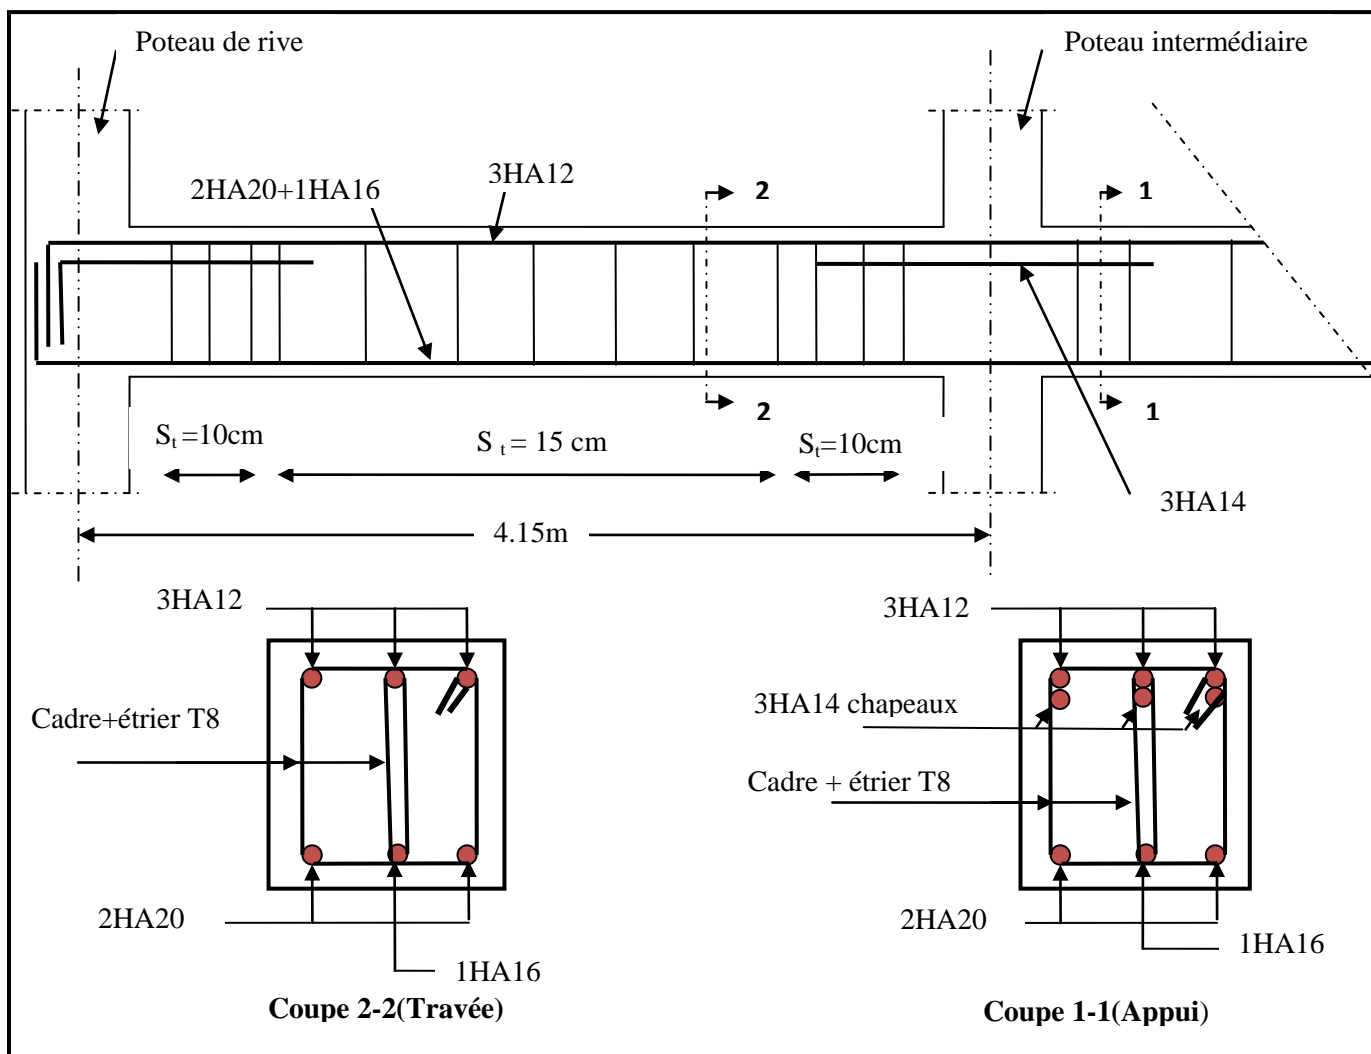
Ferrailage des poutres principales des étages services et d'habitation.
